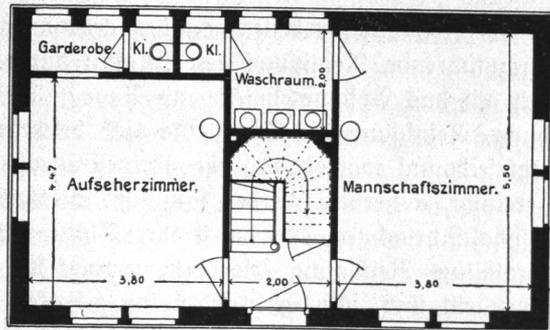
Straßenreinigungsgebäude, Grundriß.
